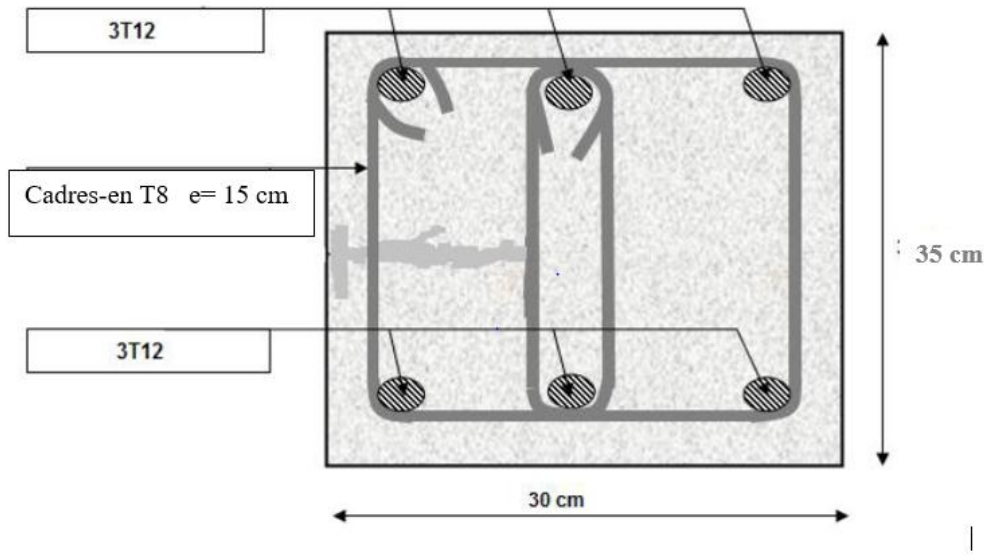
Ferrailage de la poutre palière en travée et en appuis
